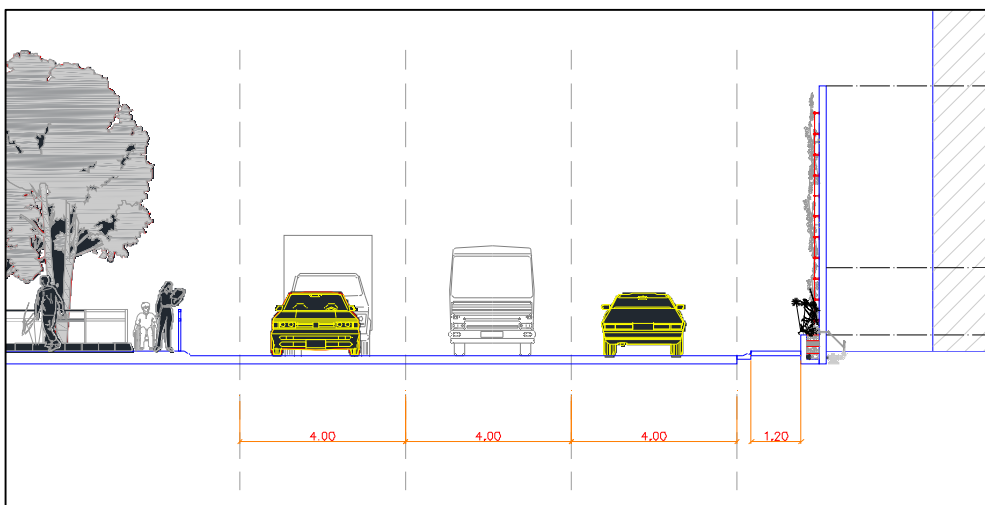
Perfil de segunda zona de intervención (margen derecha con acera de 1.2 m y muro verde).
